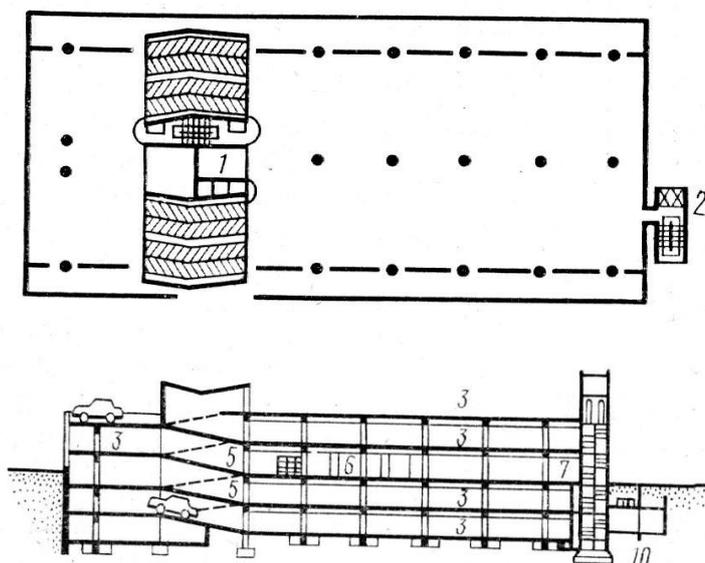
Многоэтажный гараж в Штутгарте. План наземного этажа, эксплуатируемой кровли, разрез.
